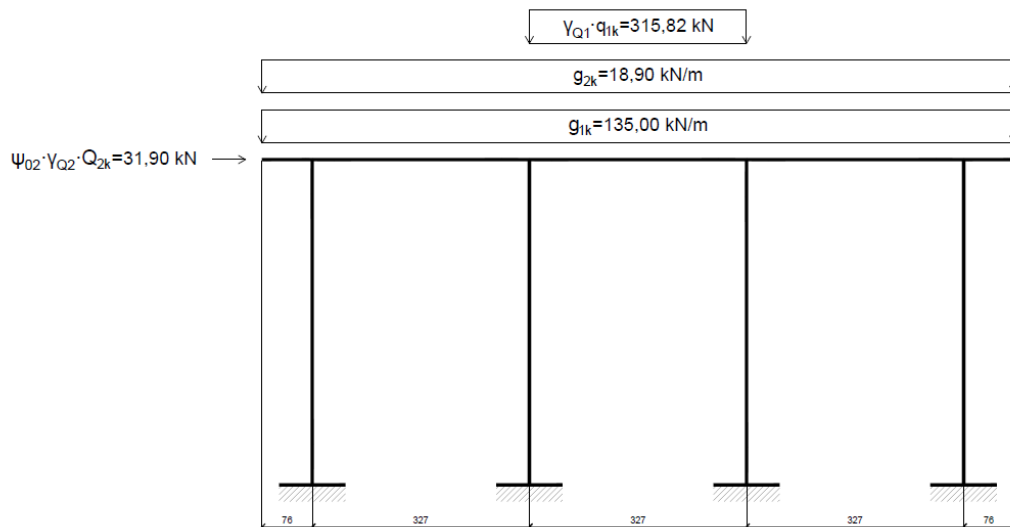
Schema statico della pila della US2 allo stato di progetto in combinazione SLU5.
